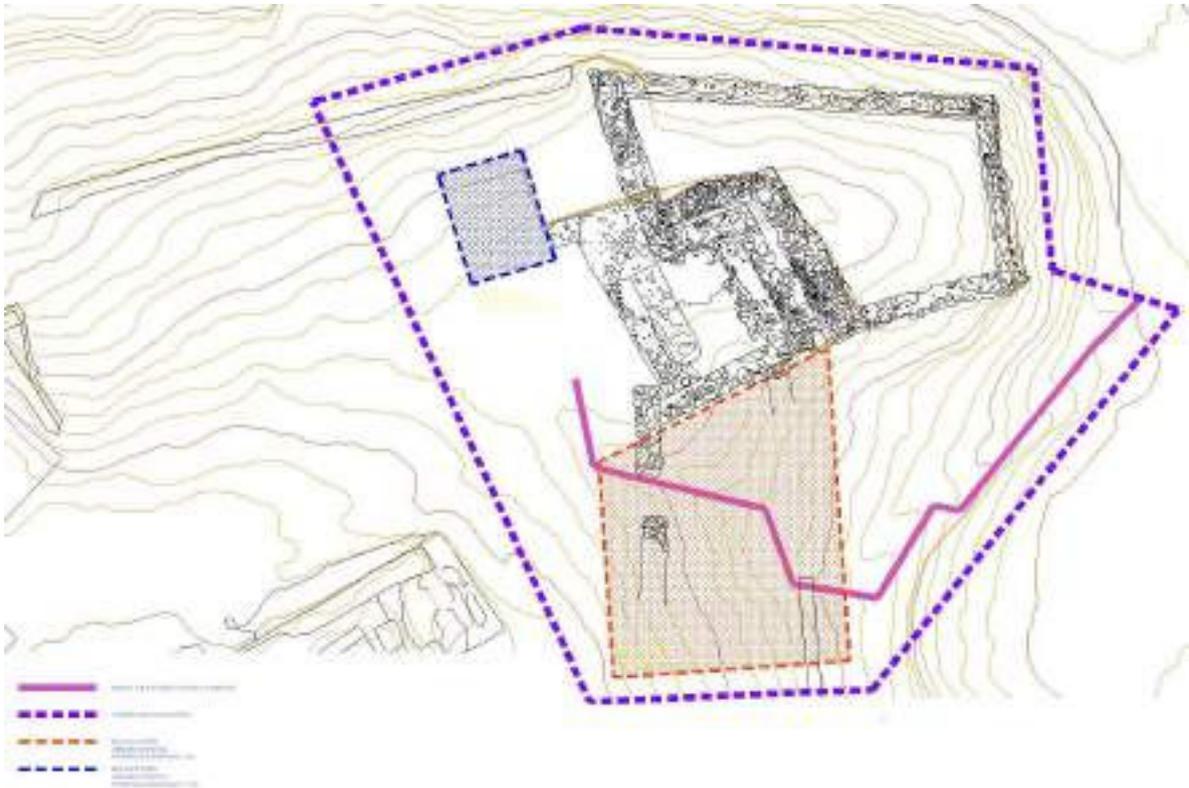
, vista zona de actuación (en morado) y zonas de excavación (en rojo y azul)
